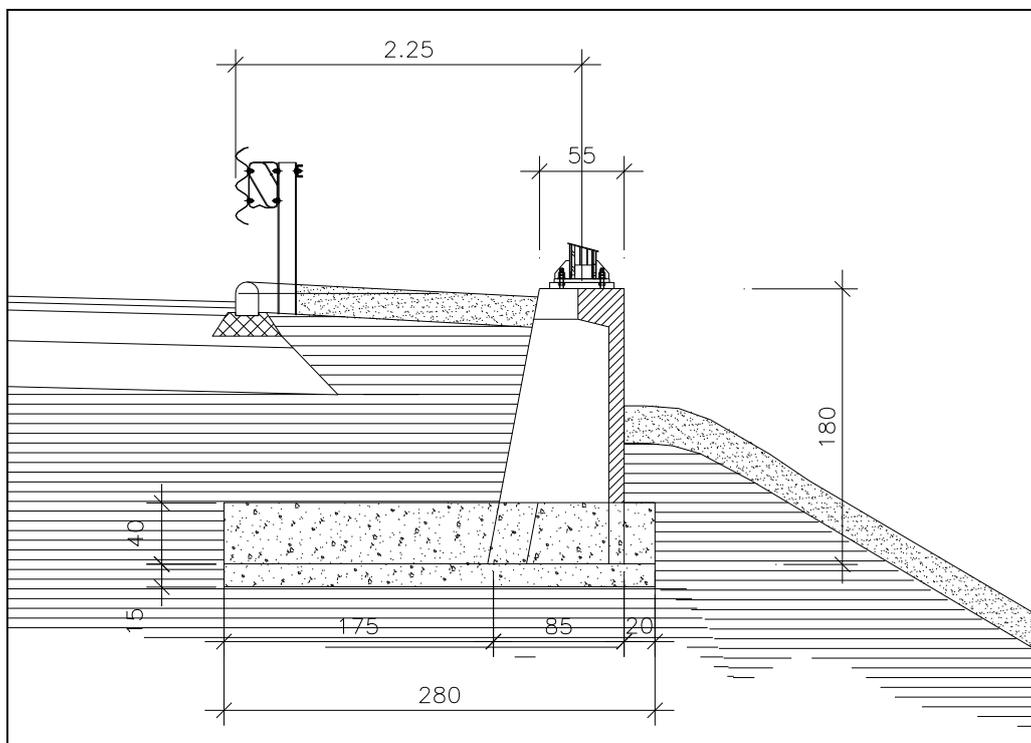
Tipologico muro H=1.80 m porta FOA su fondazione diretta
